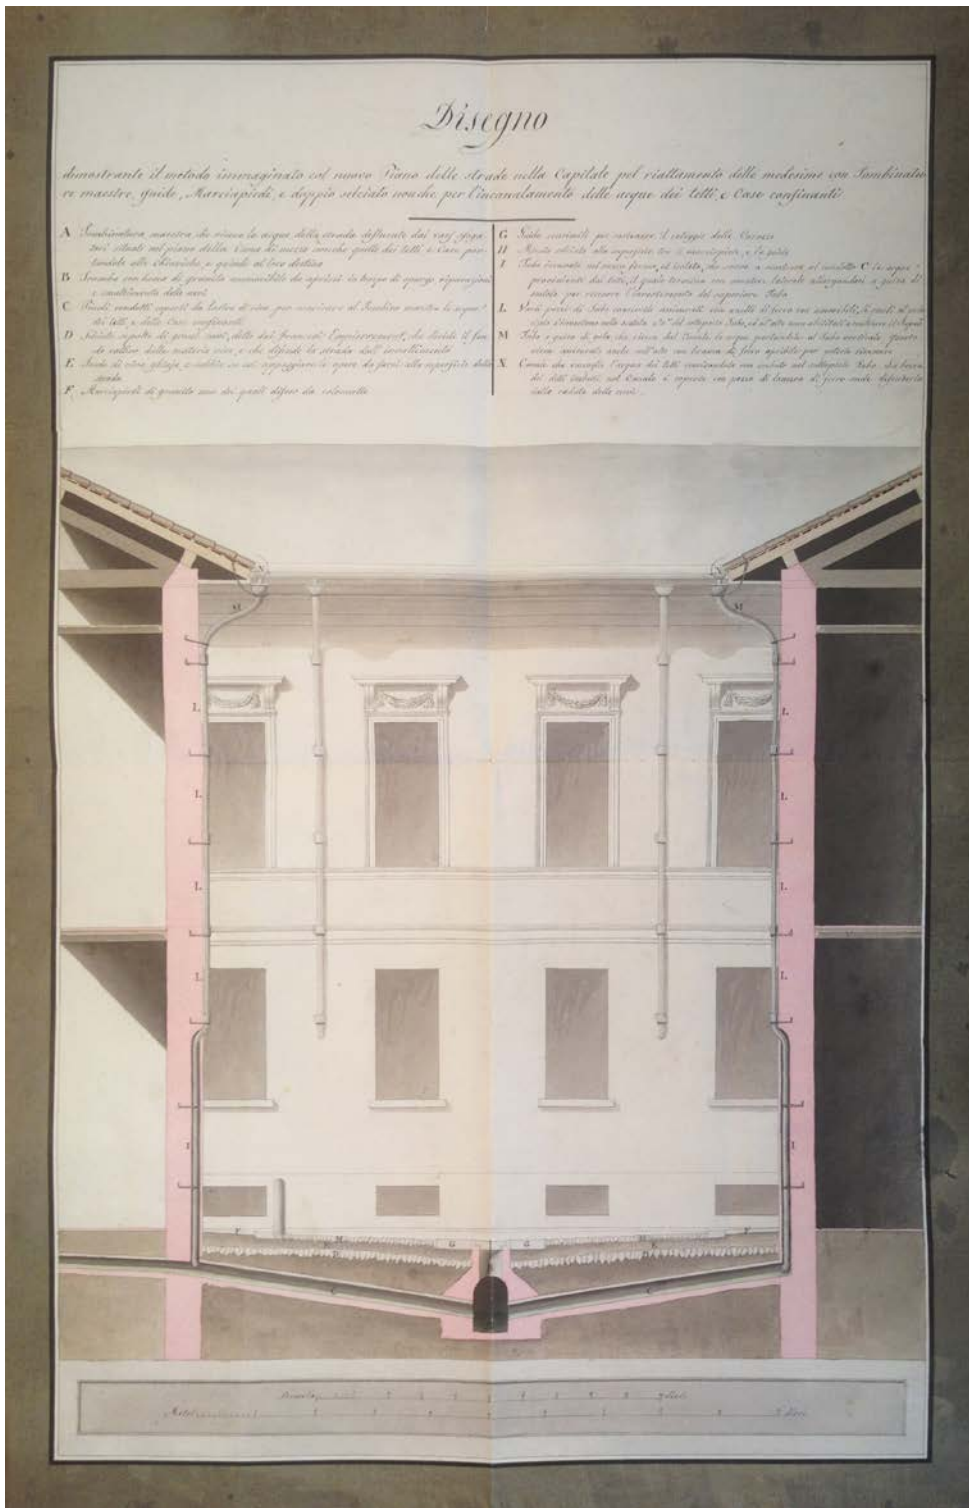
Coupe représentant le système constructif élaboré par les ingénieurs de la Direzione Generale d'Acque e Strade pour la reconstruction des principales chaussées de Milan, sans date [1807]. Archivio di Stato di Milano, Genio Civile, 1622, f. 1.
